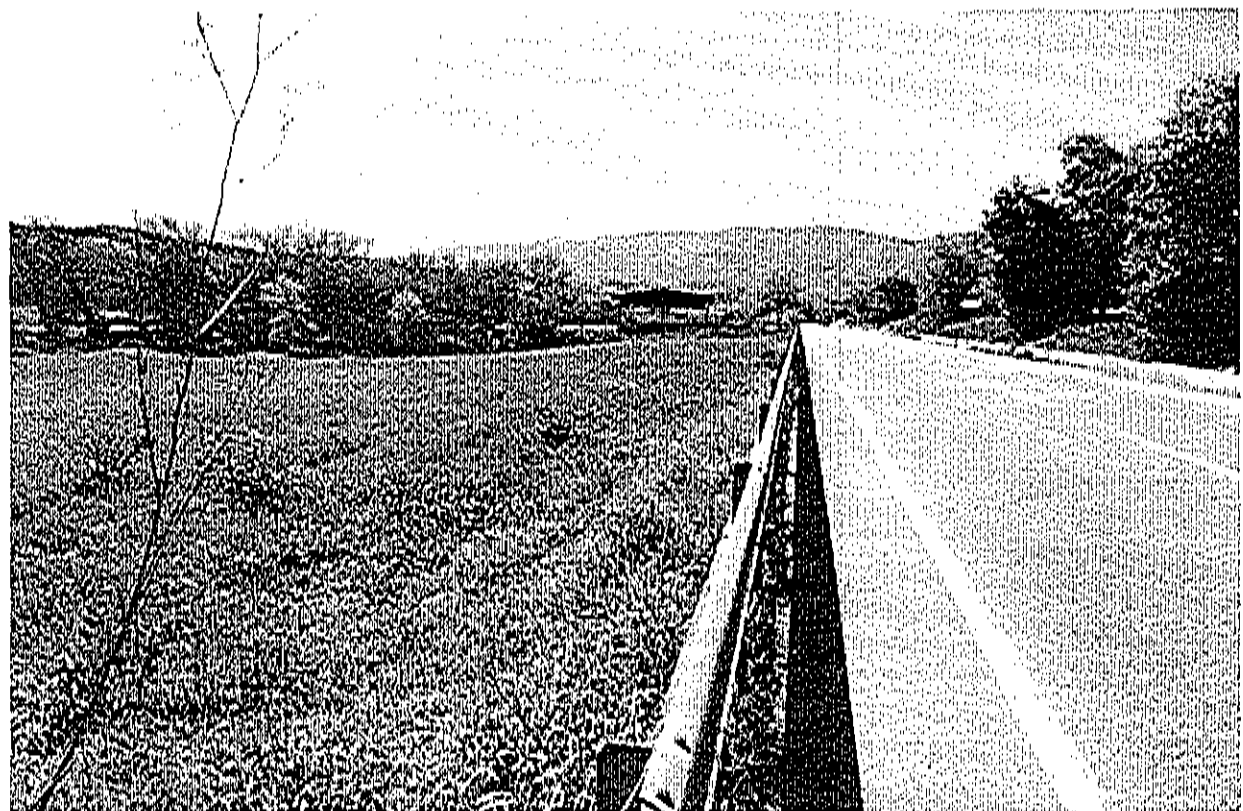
Lotto 1 - via Alimena adiacente al lotto
